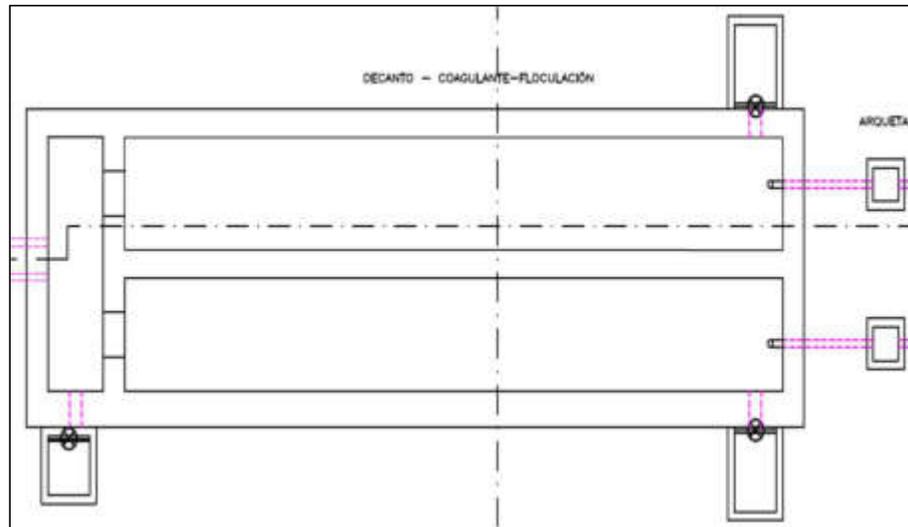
Vista en planta de Cámara de Decanto – Coagulante – Floculación
